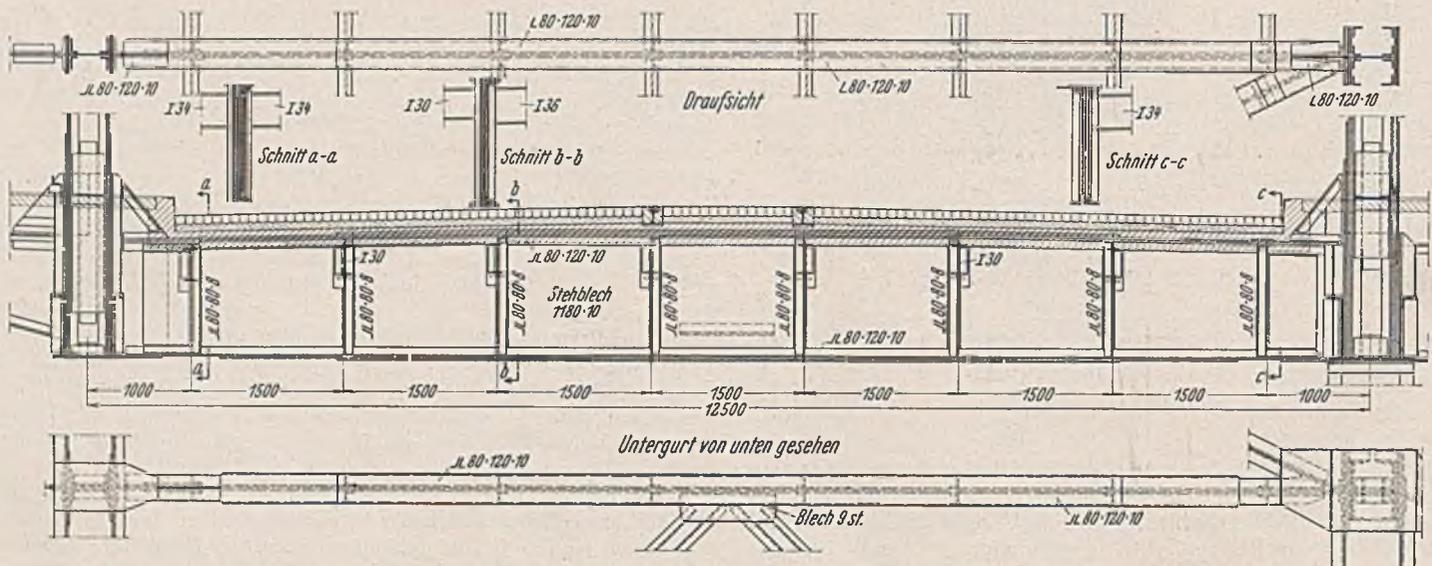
Feste Brücken. Fahrbahnquerschnitt einer Brückenhälfte
